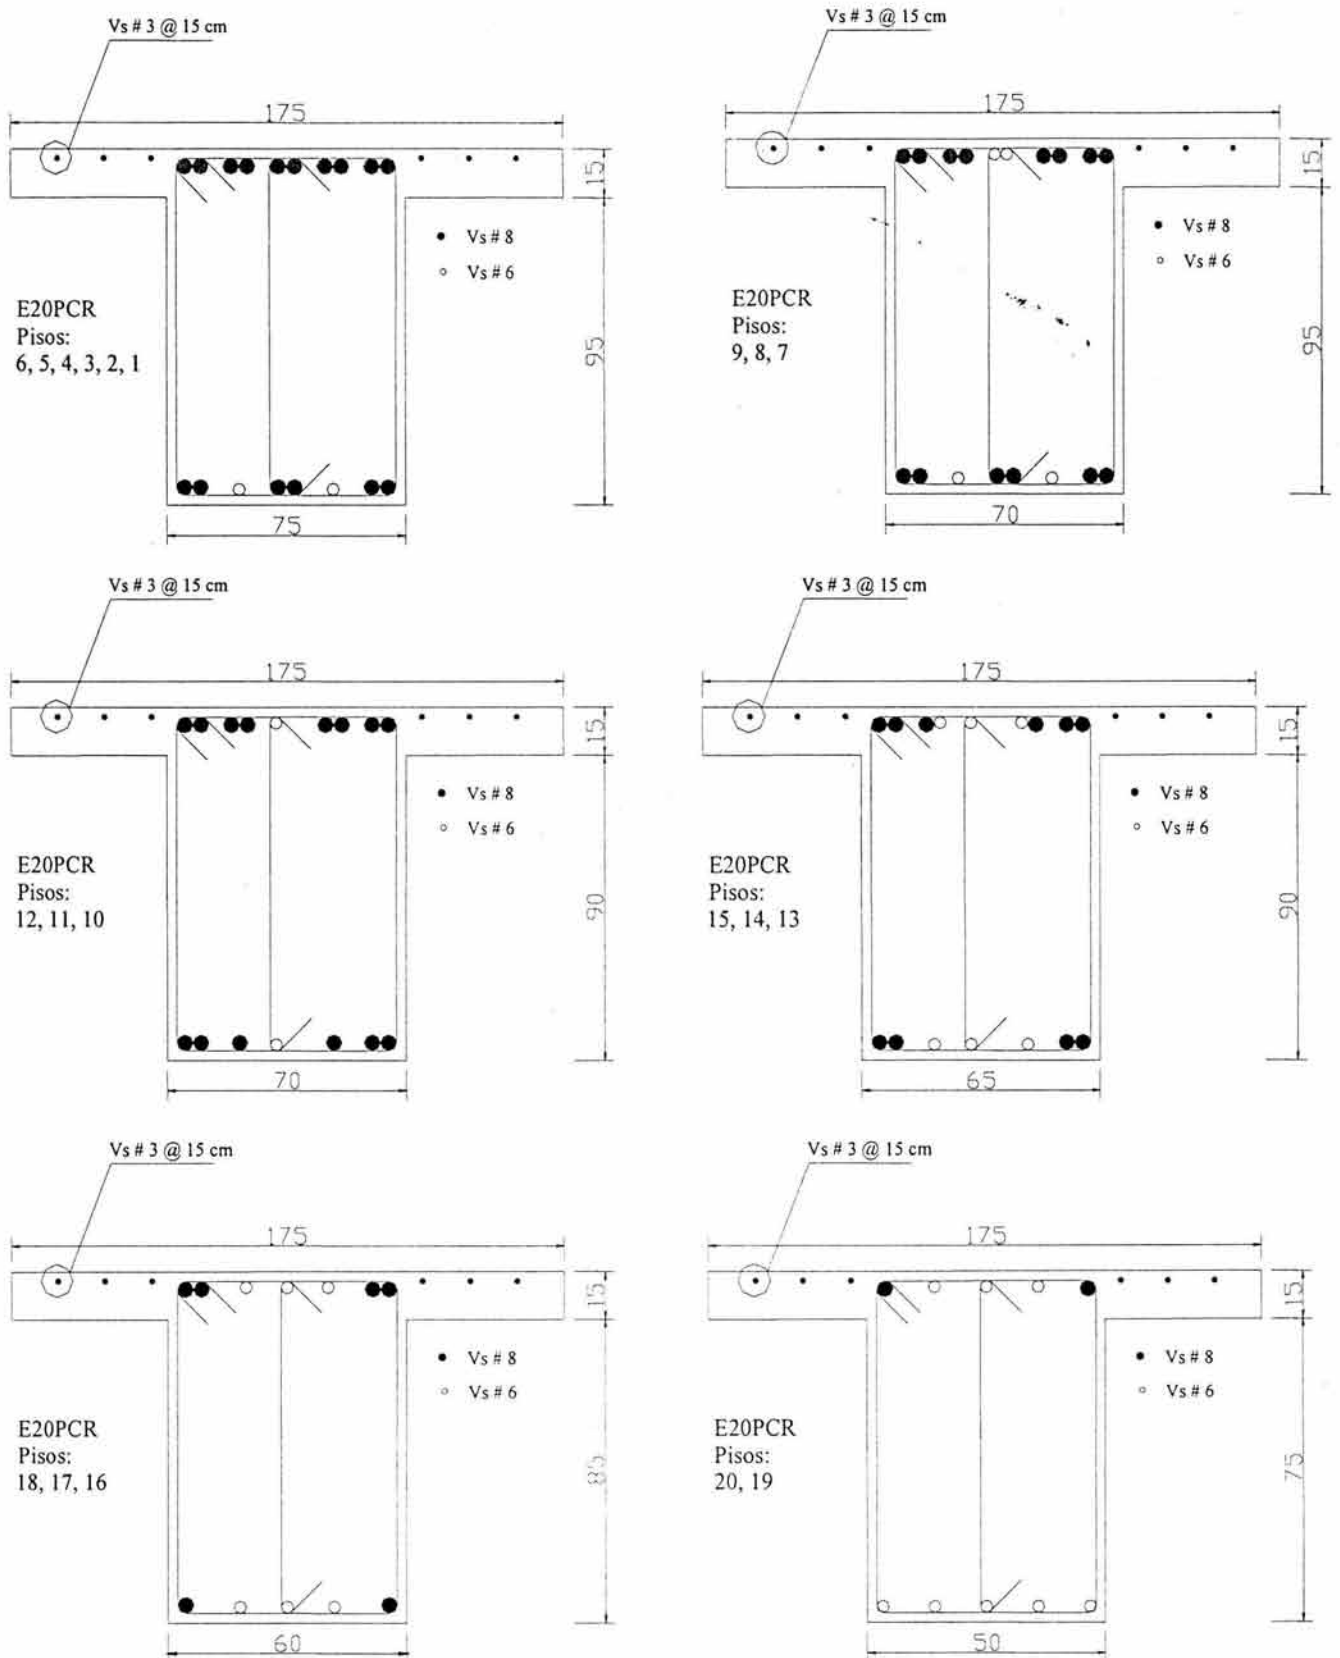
Detallado de vigas en edificio de 20 niveles.
